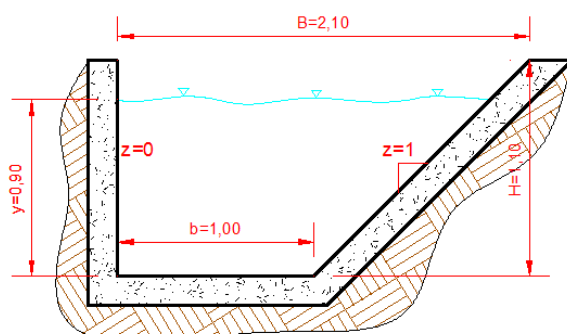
Esquema de canal propuesto en concreto trapezoidal en alternativa 2.
